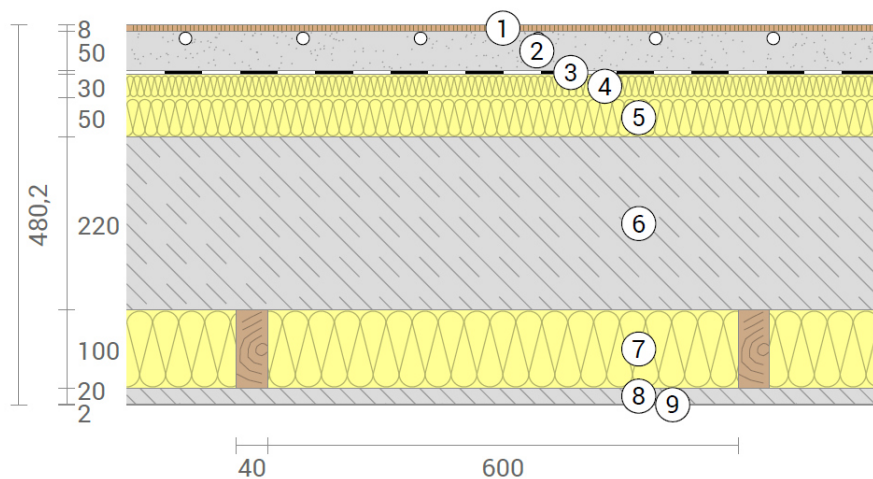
Bauteilaufbau der Kellerdecke im Wohnbereich (KNB-Variante)
